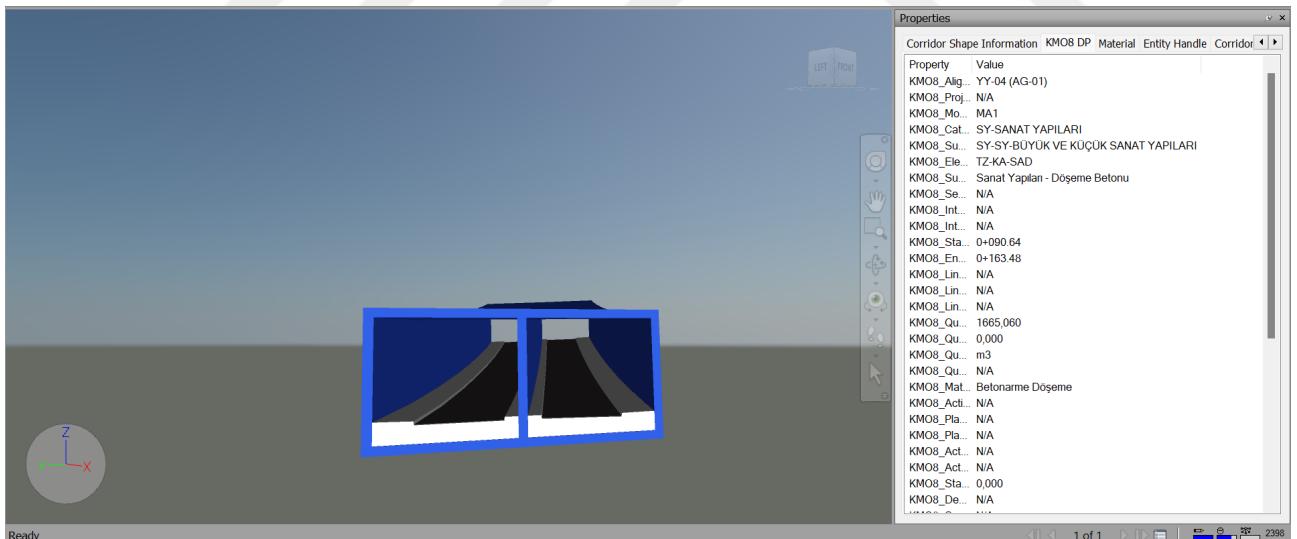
Sanat yapıları- üst geçit köprüsü kiriş modeli.
